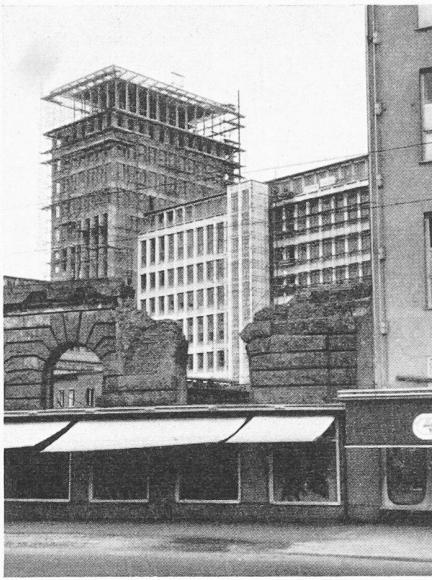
Der Turm der Fernmeldebauden. Im Vordergrund noch zerstörte Geschäftsstrasse, in der einstöckige Ladenbauten so lange provisorisch eingerichtet sind, bis die Finanzierung des Wiederaufbaus sichergestellt ist
